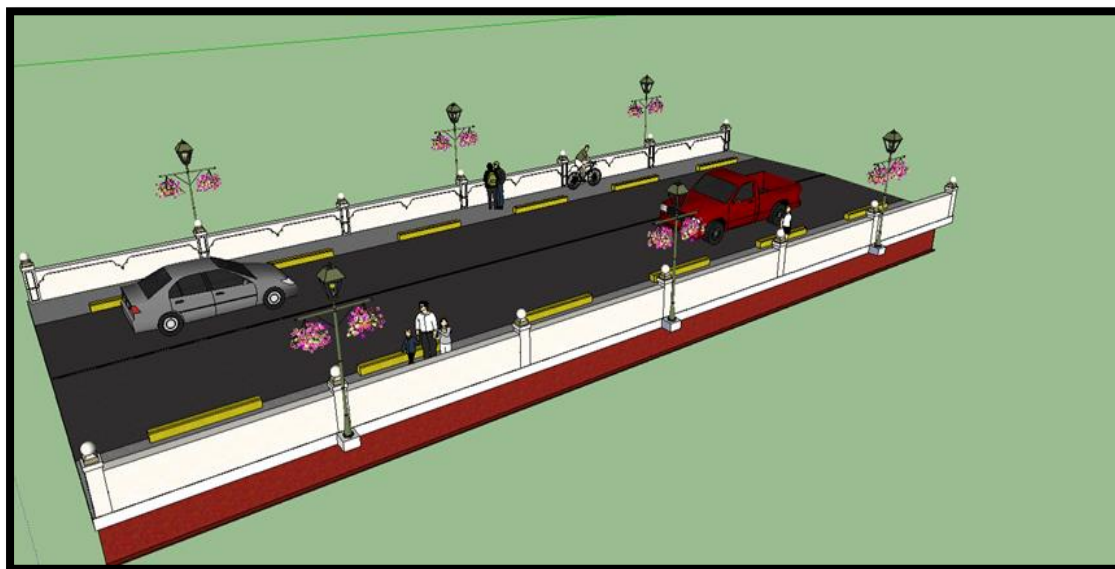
superestructura de puente Guadalupe, Orientación Norte – Sur
